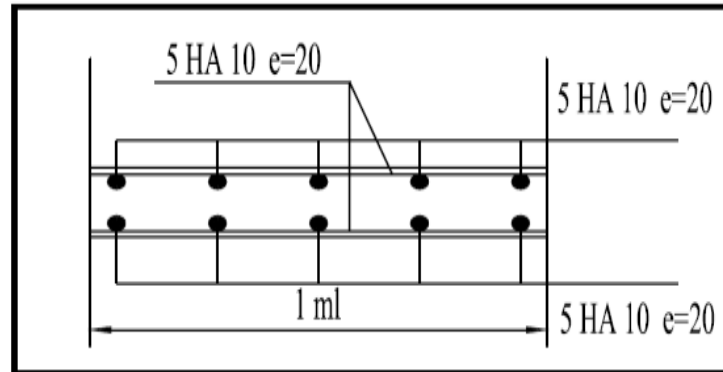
Schéma de ferrailage de la dalle Pleine.
